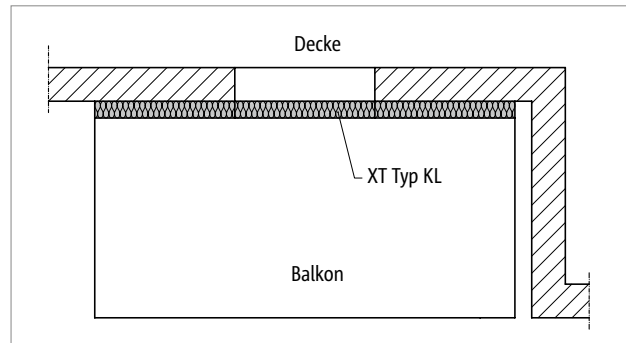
Schöck Isokorb® XT Typ KL: Balkon bei Fassadenversprung
